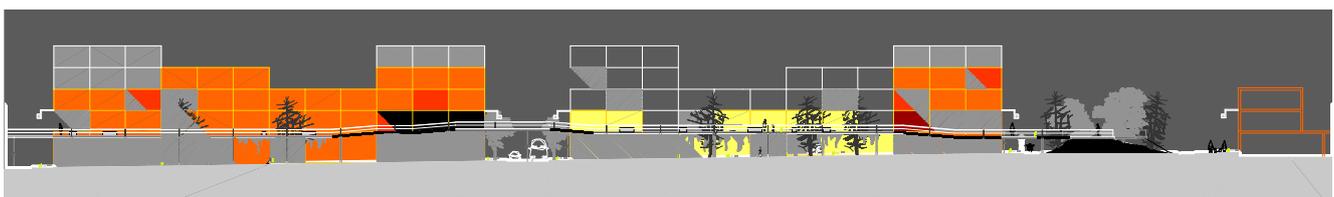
Plano de detalhe 2&2 – Corte mostrando a ‘sub-promenade’ elevada.
